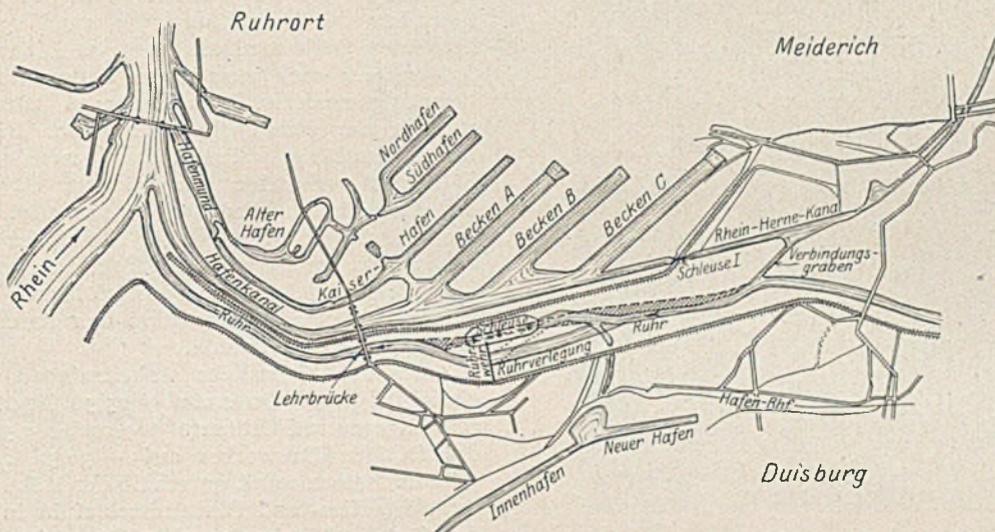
Übersichtsplan mit Schleusenbaustelle.
